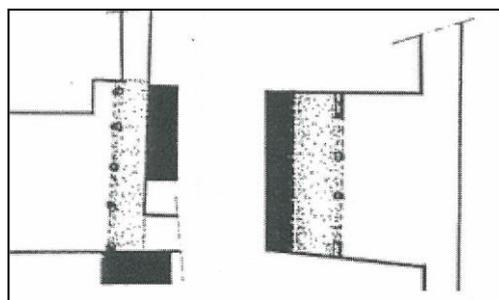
Galerie public avec trois façades et Galerie approprié avec une seule façade.
